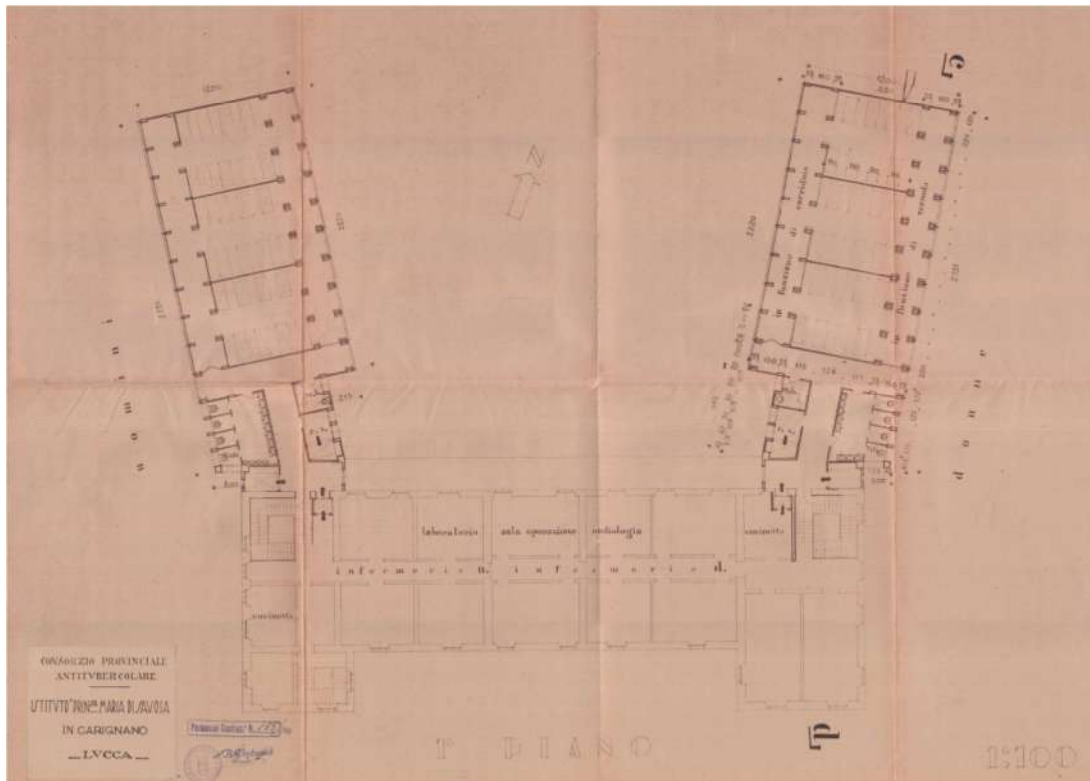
pianta piano primo con l'ampliamento delle ali in c.a..
